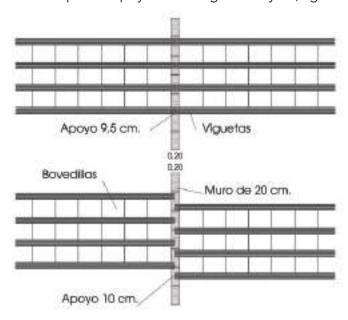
Apoyo mínimo de viguetas sobre muro interior
